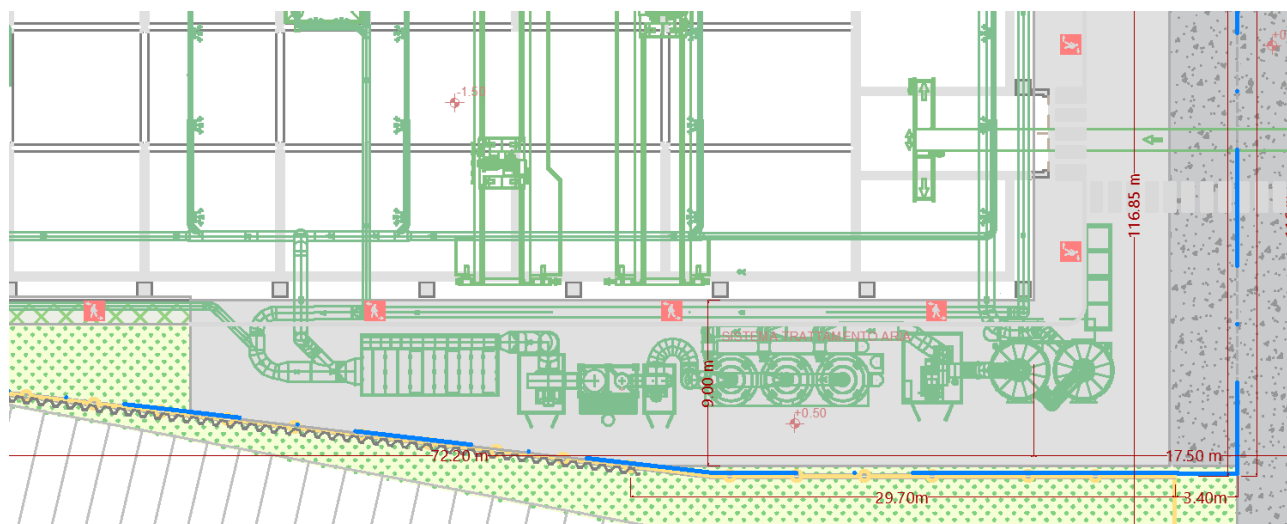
Sistema di trattamento aria, versione attuale – Impianto SRA - Pianta
